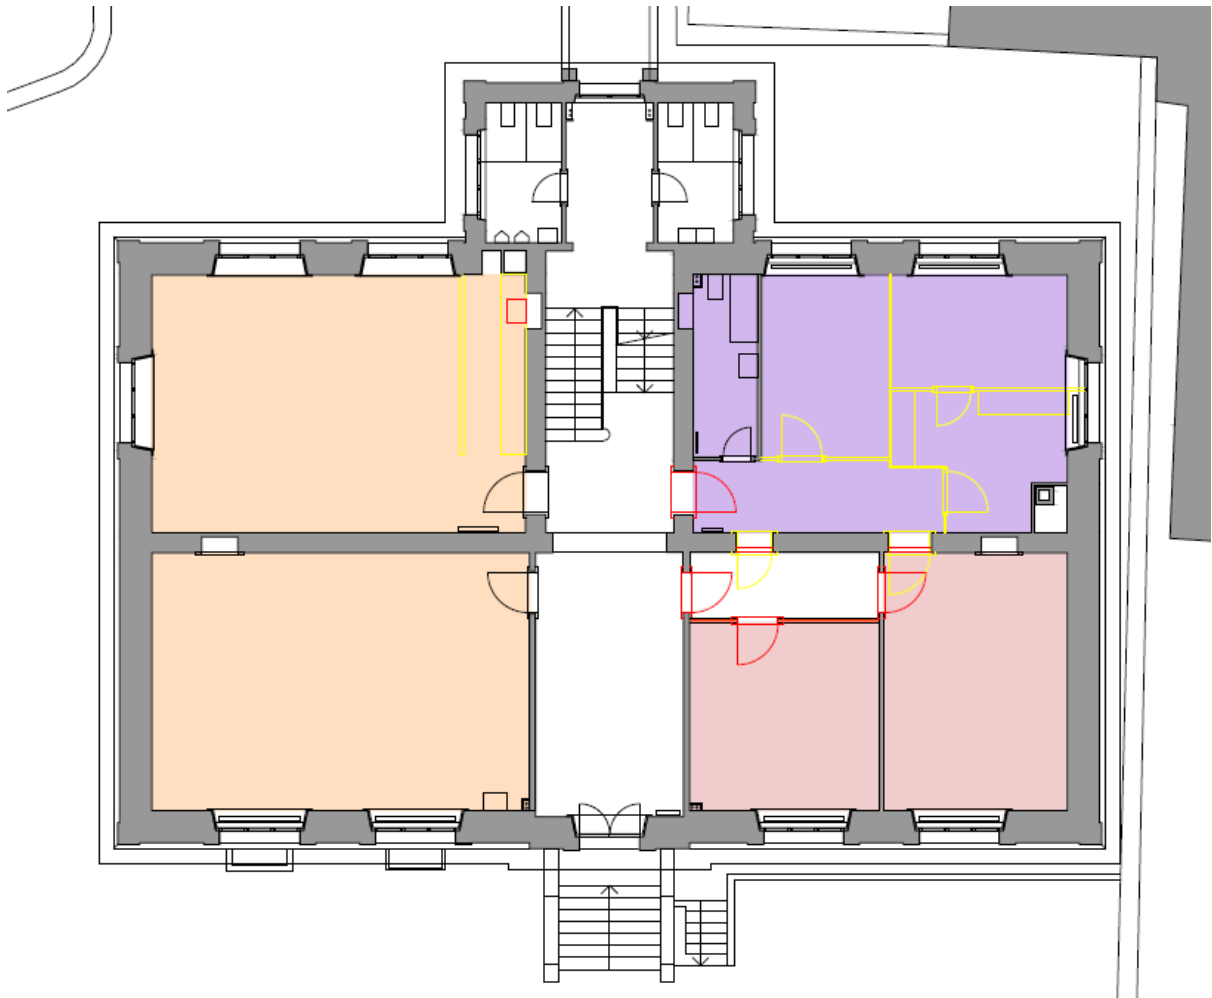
Plan du rez-de-chaussée du collège des Sablons adapté.
